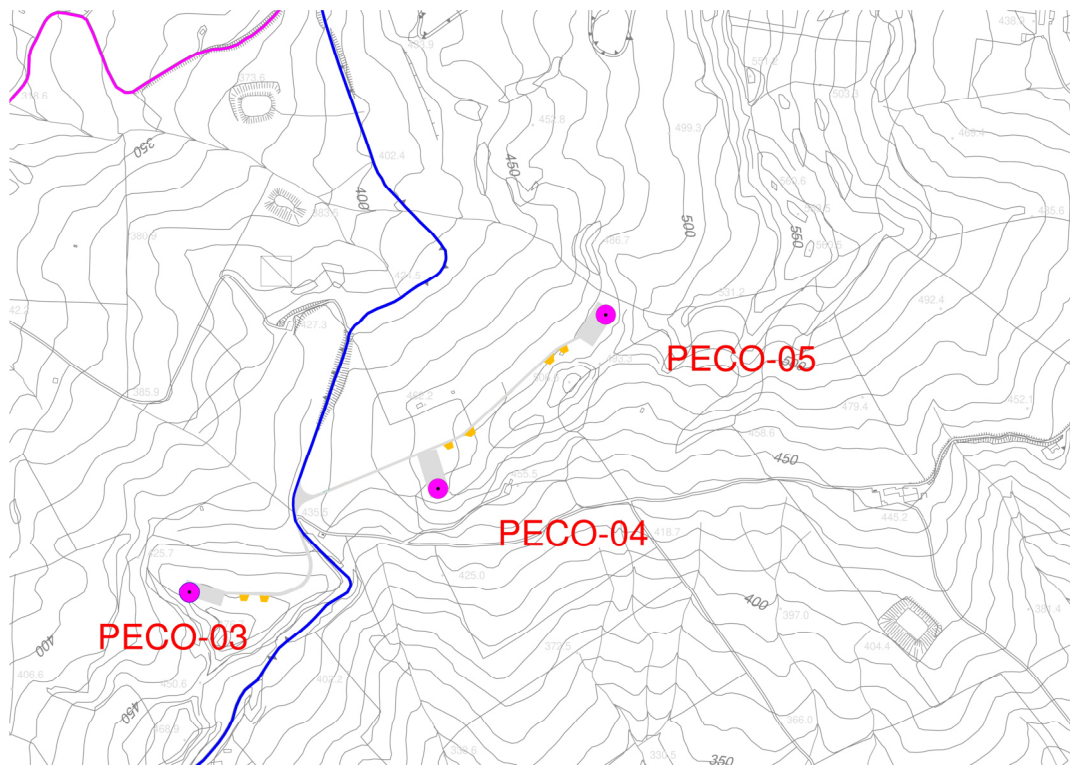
Planimetria delle strade di cantiere scala 1:5.000
